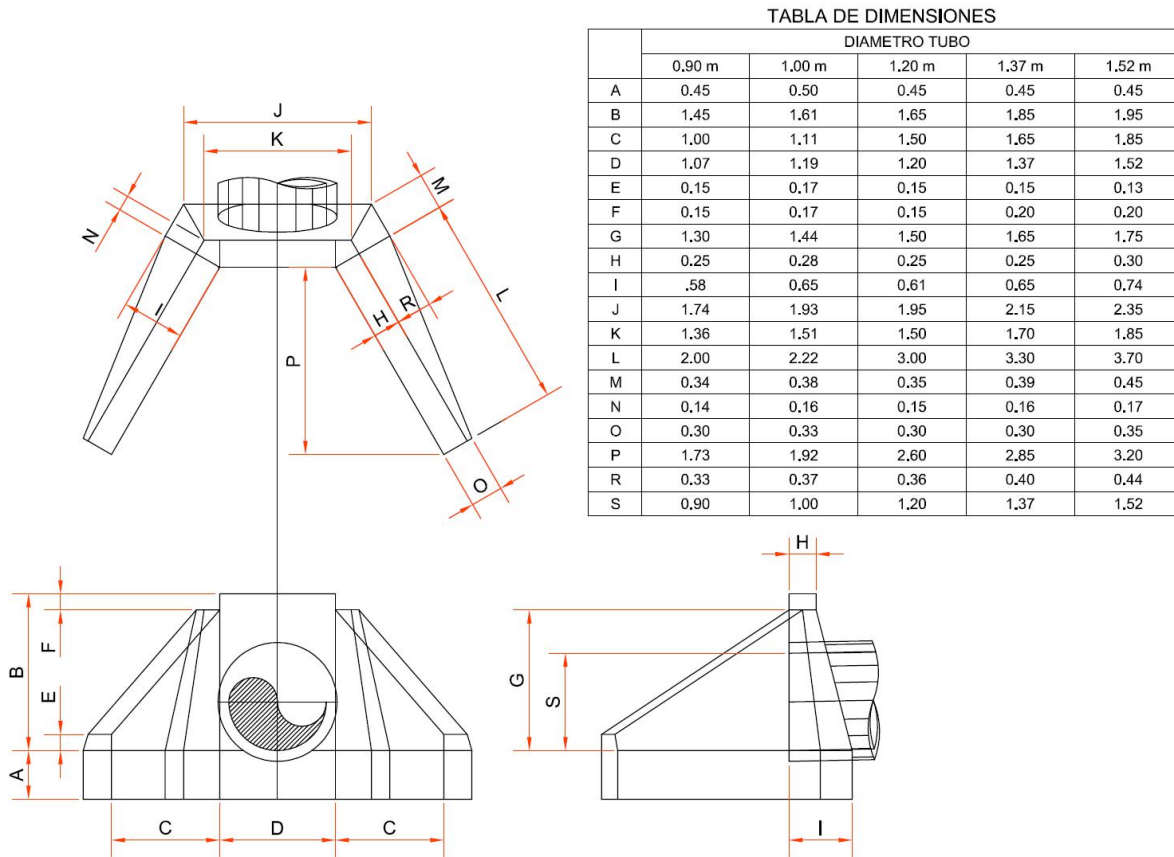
Detalle típico de cabezal de salida de alcantarillado
